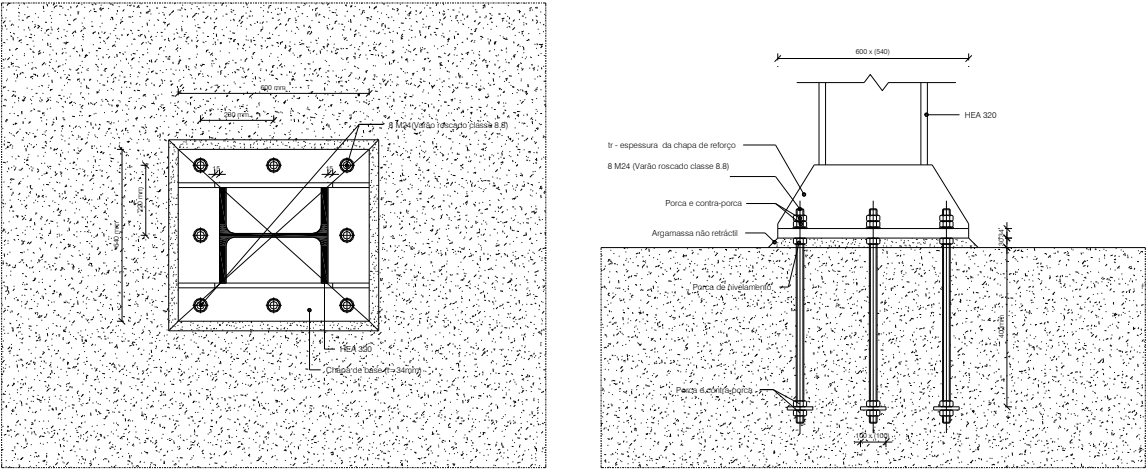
Pormenores construtivos (em planta e corte) da ligação tipo 2 do caso de estudo. [SE2P]
